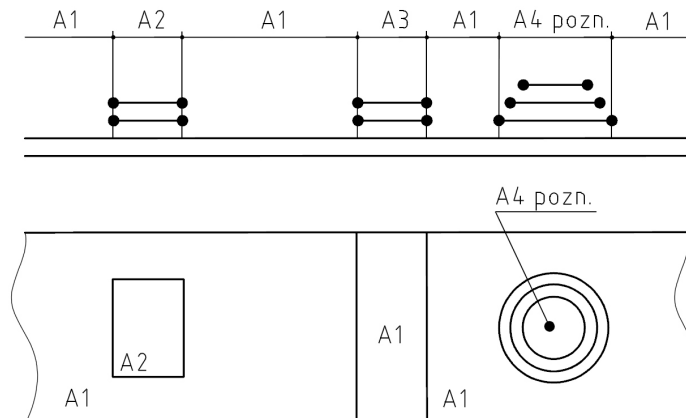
Spojení okraj - okraj, převzato [4]
